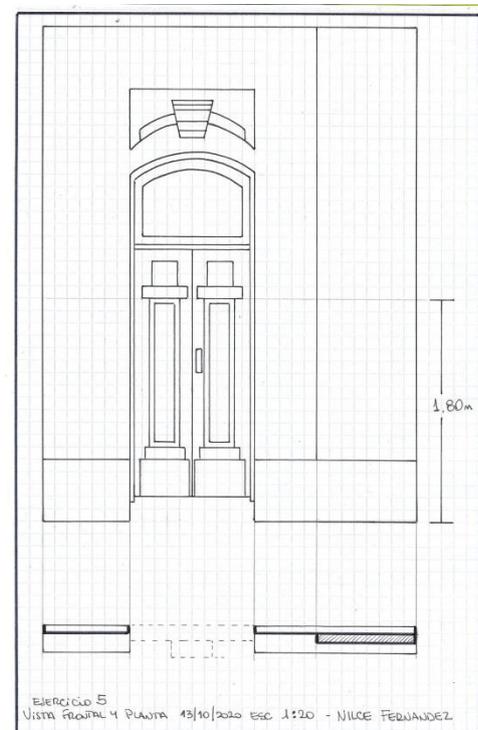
Trabajo de vista en planta y frontal - Estudiante Nilce Fernández
